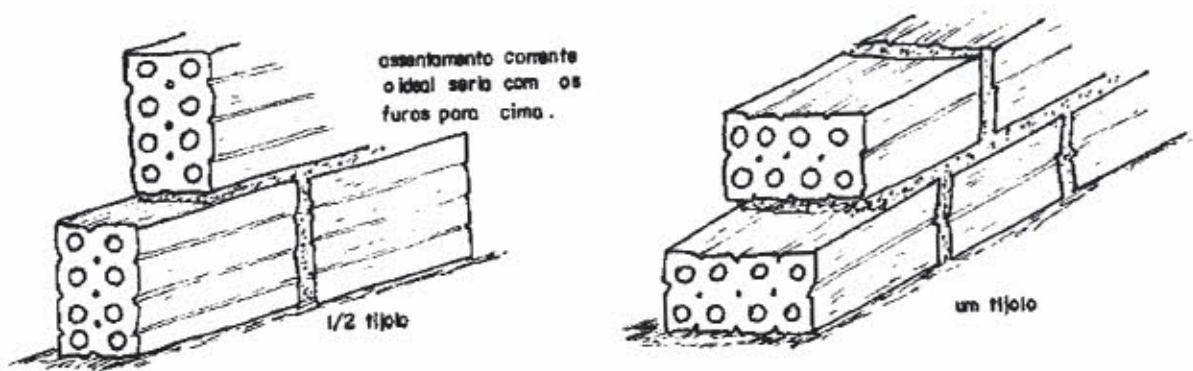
Execução de alvenaria utilizando tijolos furados.
